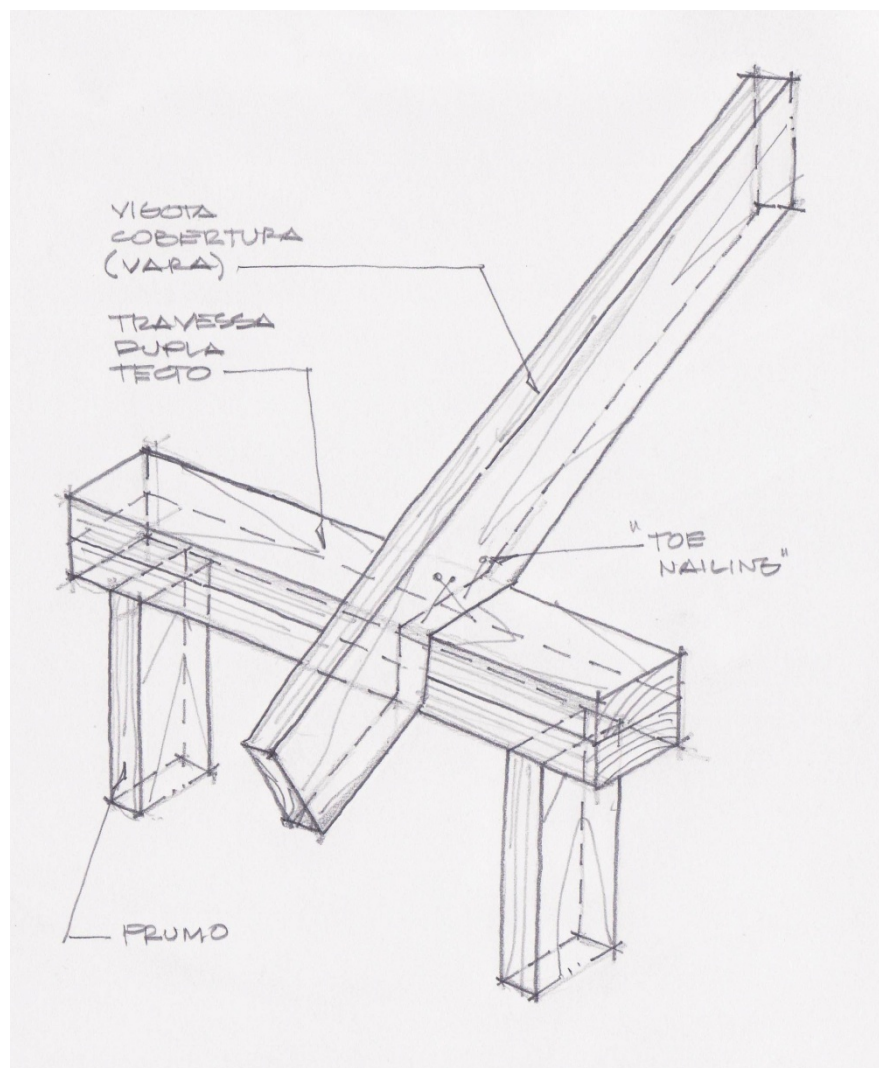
Pregagem de vigota de cobertura a apoio em parede exterior. (des. autor)
